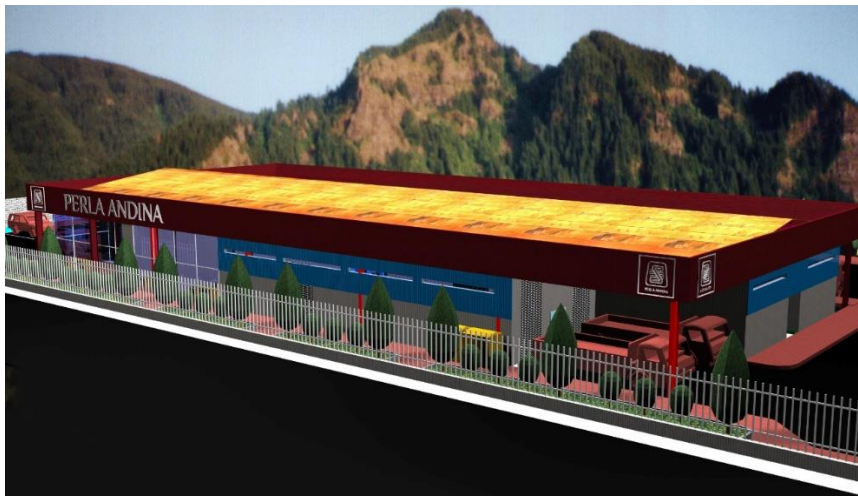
Modelado 3D de la planta industrial de vino de mortiño.
